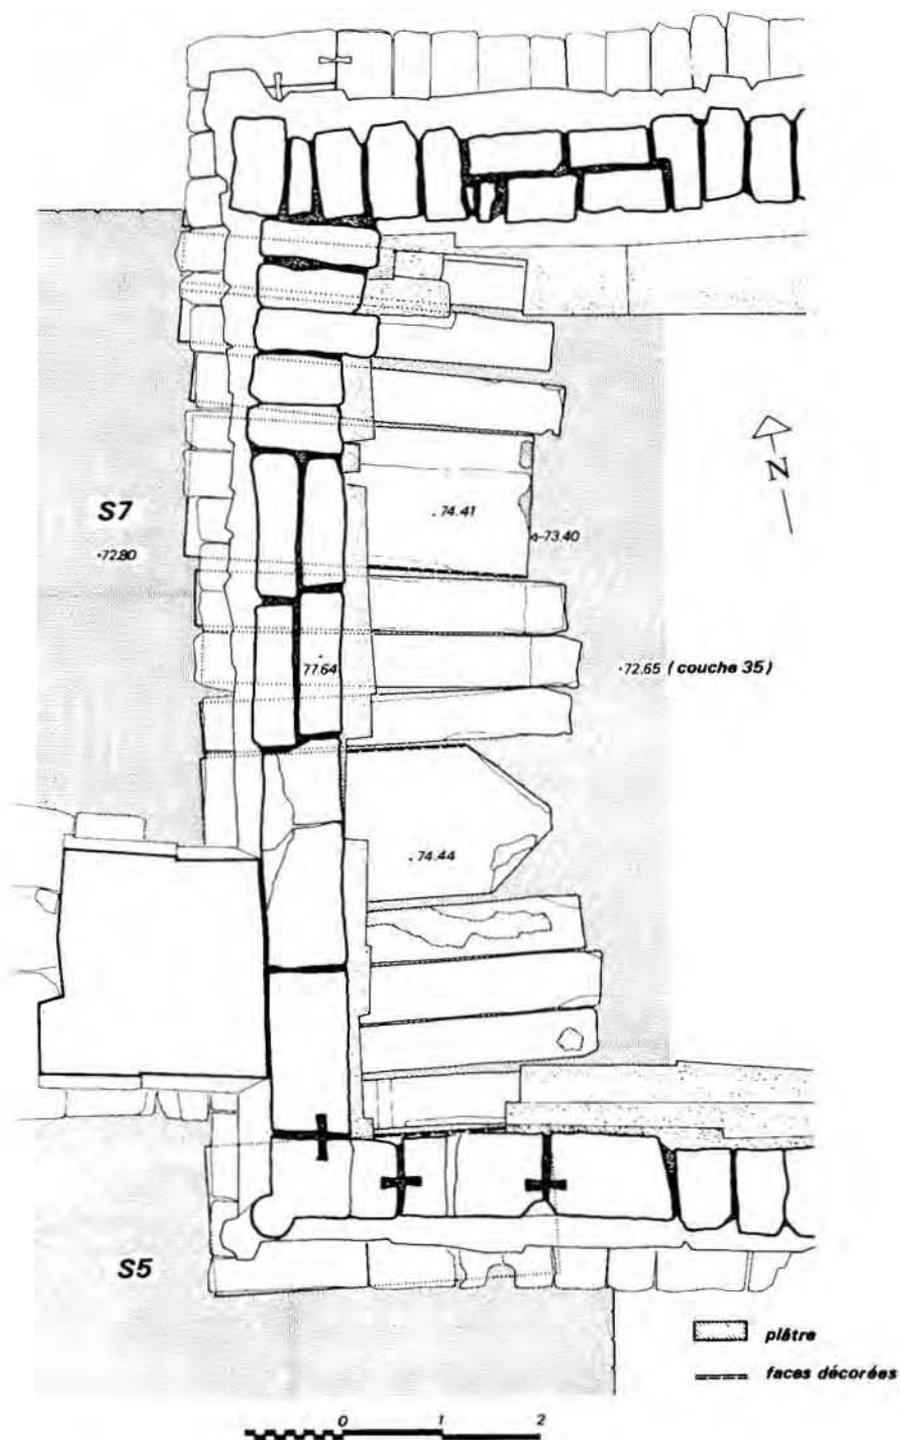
Position des architraves et des dalles de couverture renforçant la fondation du parement ouest du pylône. On rencontre du Sud au Nord une architrave (visible sur la planche I/b depuis l'extérieur), quatre dalles de couverture posées de champ, une architrave taillée en prisme, trois dalles, une architrave rectangulaire, et probablement quatre dalles suivies d'une dernière architrave sous l'angle nord-ouest du monument. Trois des architraves présentent des faces décorées. Relevé/Dessin : M. Azim/C. Simonnet.
